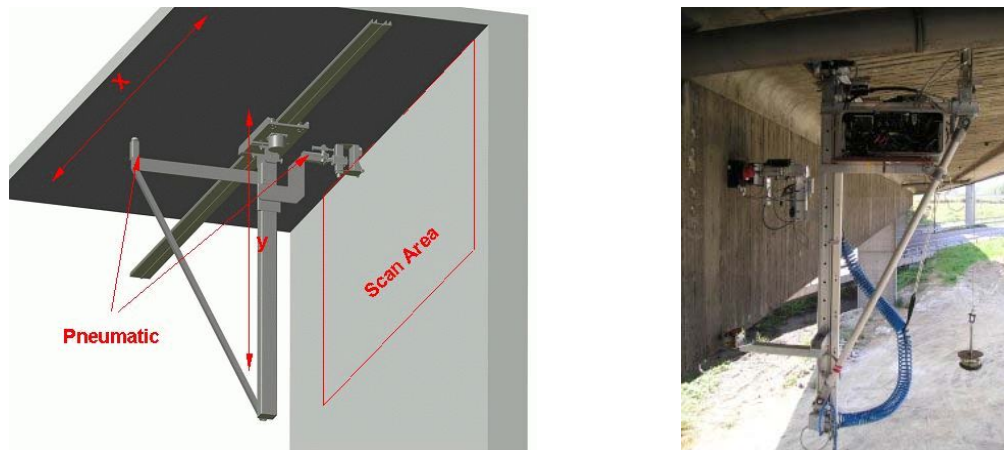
Scannersystem zur automatisierten Anwendung der zerstörungsfreien Prüfverfahren, links: Schematische Darstellung, rechts: System mit Ultraschallecho und Impact-Echo-Prüfkopf
